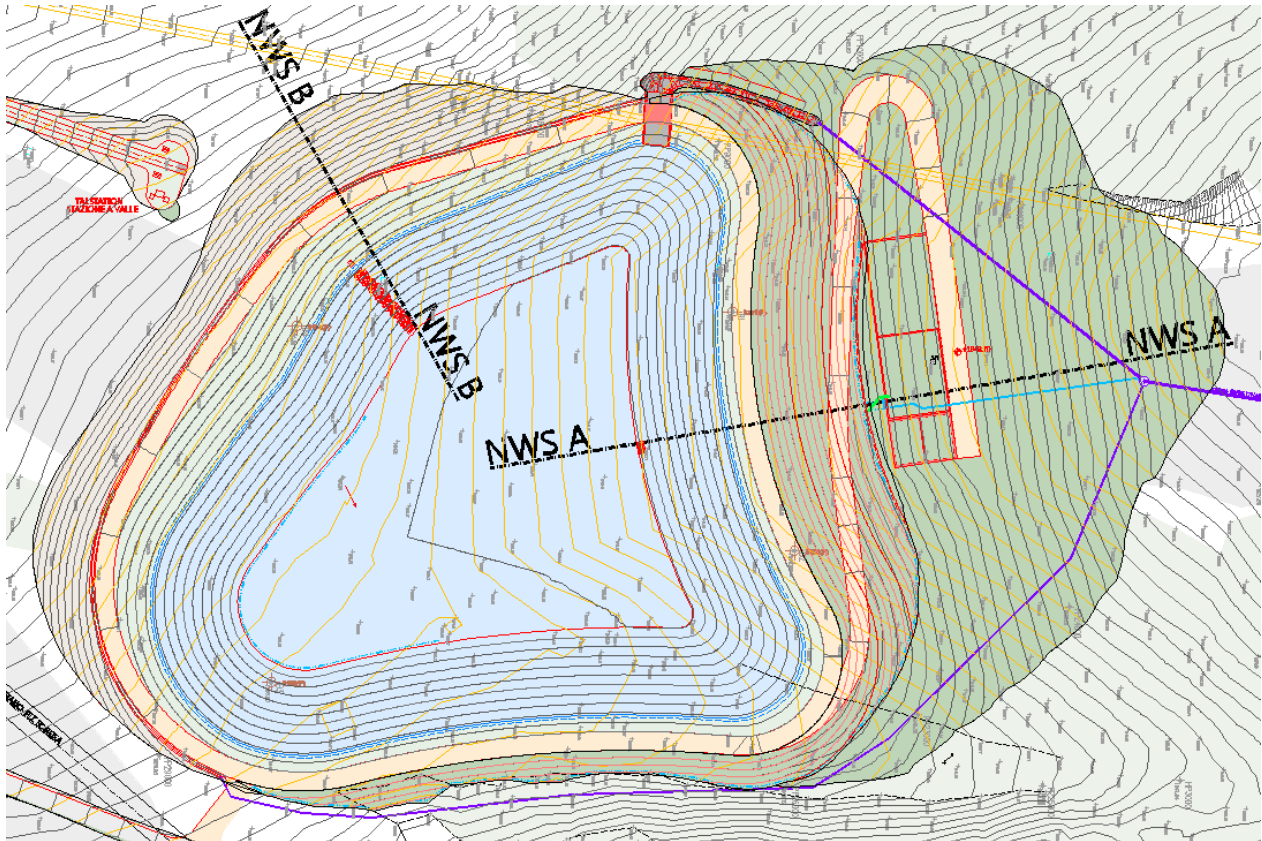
Lageplan Speicherbecken mit Nachweisschnitten
